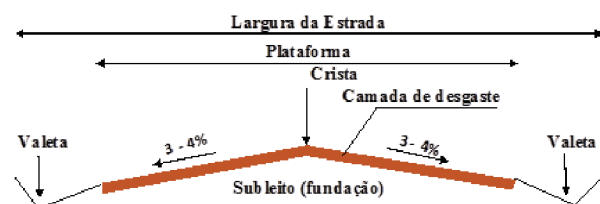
Exemplo de secção de tipo de estrada não revestida
